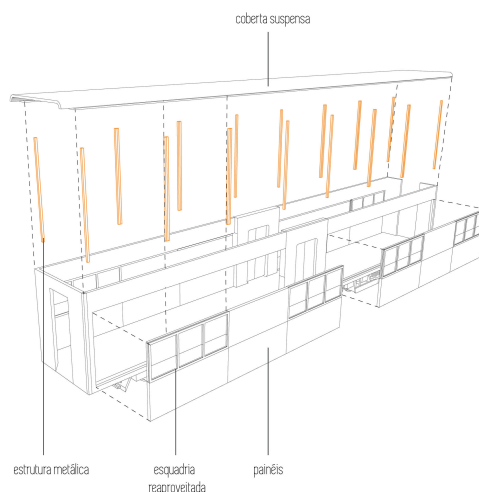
Ilustração em 3d da área detalhada na implantação. Acervo pessoal, 2016.
